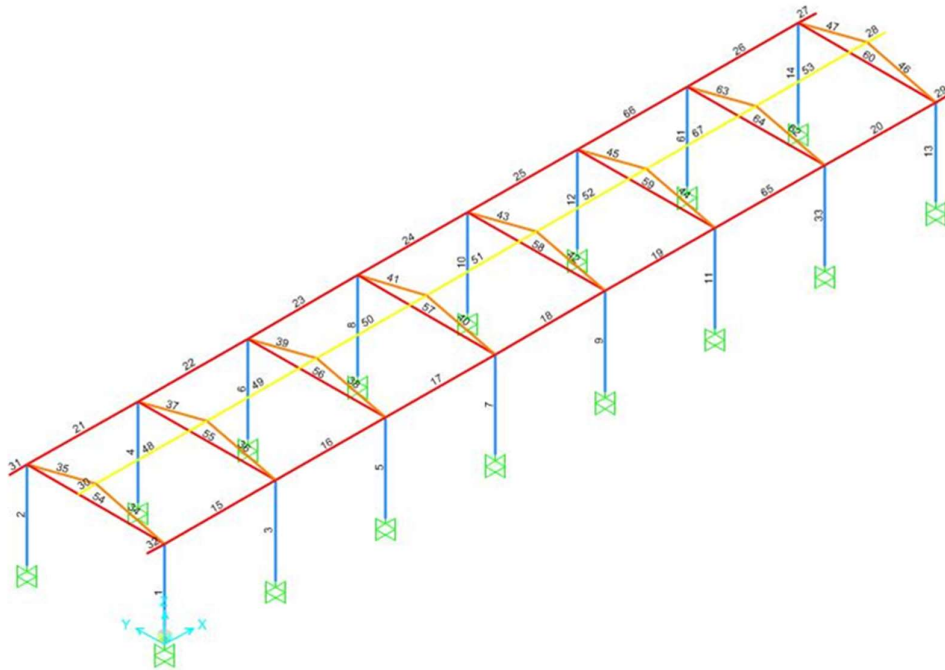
Vista assonometrica modello struttura in elevazione - numerazione elementi frame
